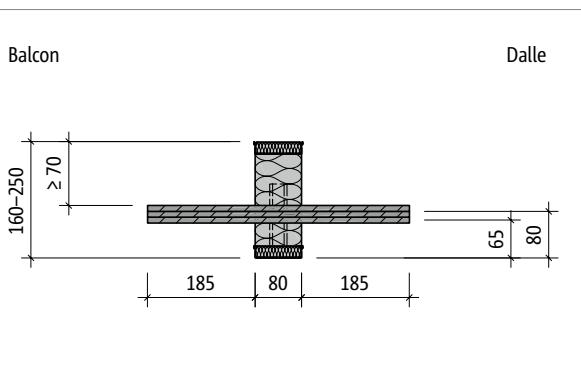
Schöck Isokorb® T Type H-VV1-NN1 : Coupe du produit
